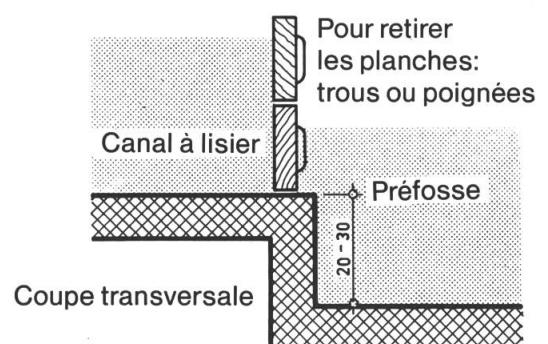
Fermeture en planches. Canaux/Préfosse.
